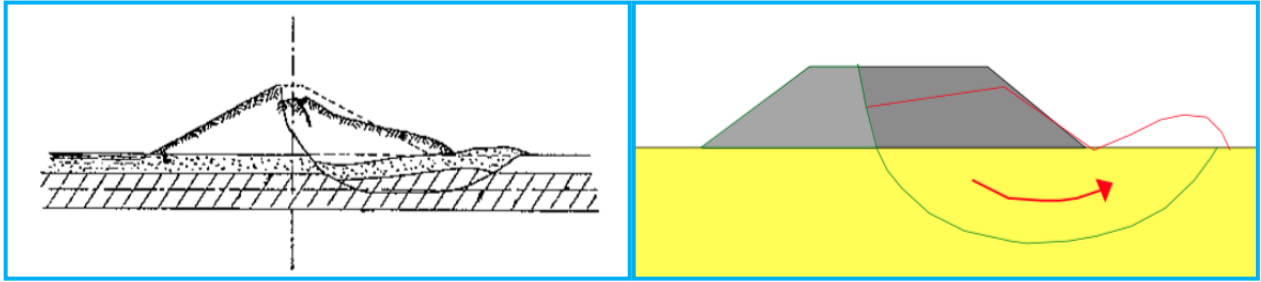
La rupture par glissement avec fissuration du remblai [7].
